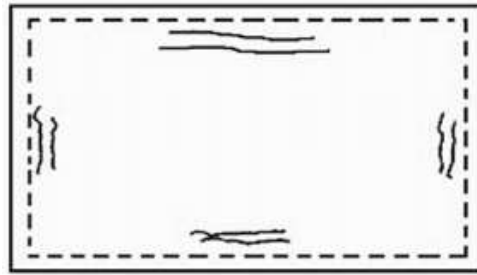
Fissuração por esmagamento na face inferior da laje, devido à deficiência de armaduras diante dos momentos negativos
